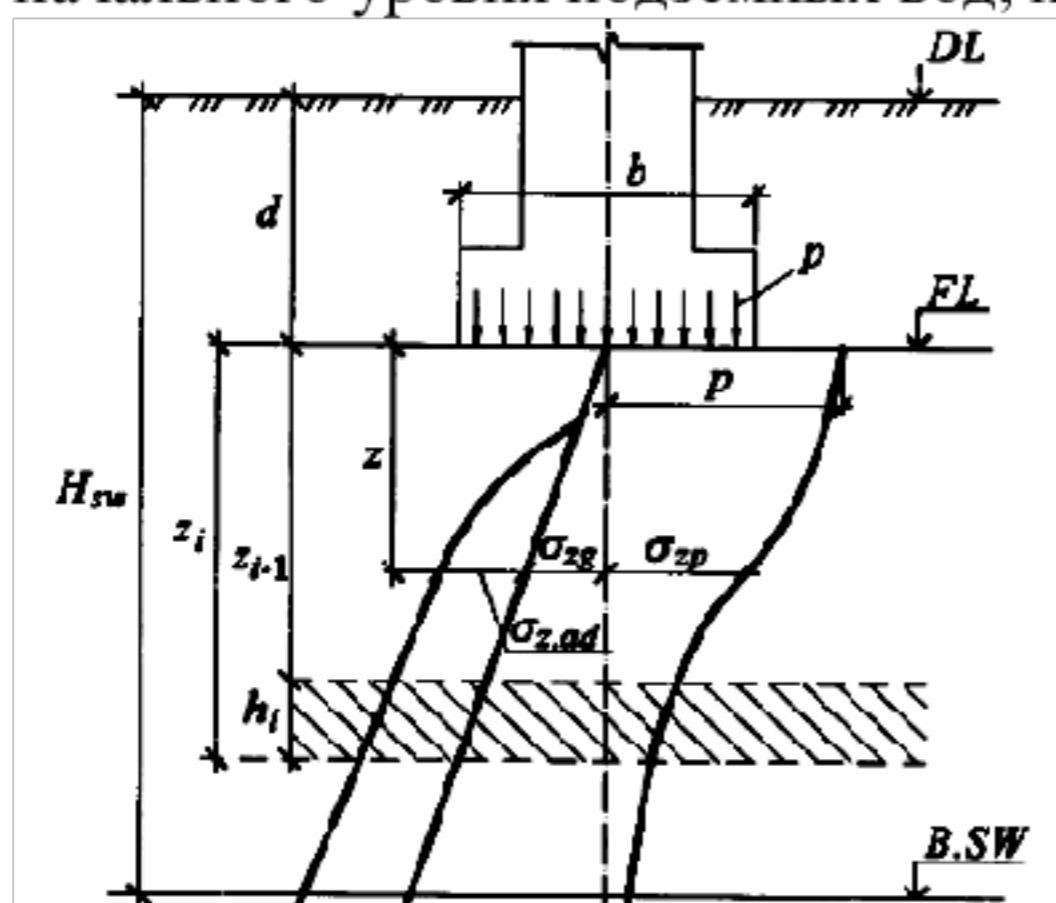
Схема к расчету подъема основания при набухании грунта
